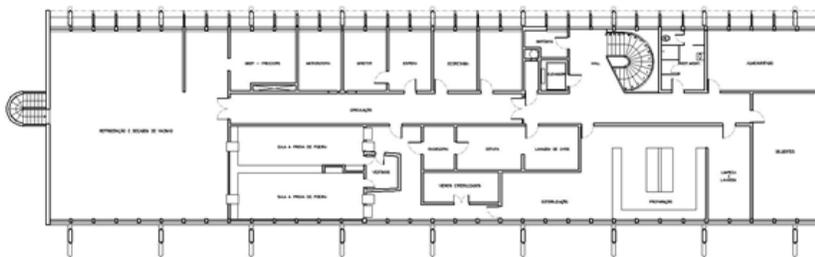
Laboratório da Febre Amarela: redesenho da planta baixa do 2º pavimento, 1954.
